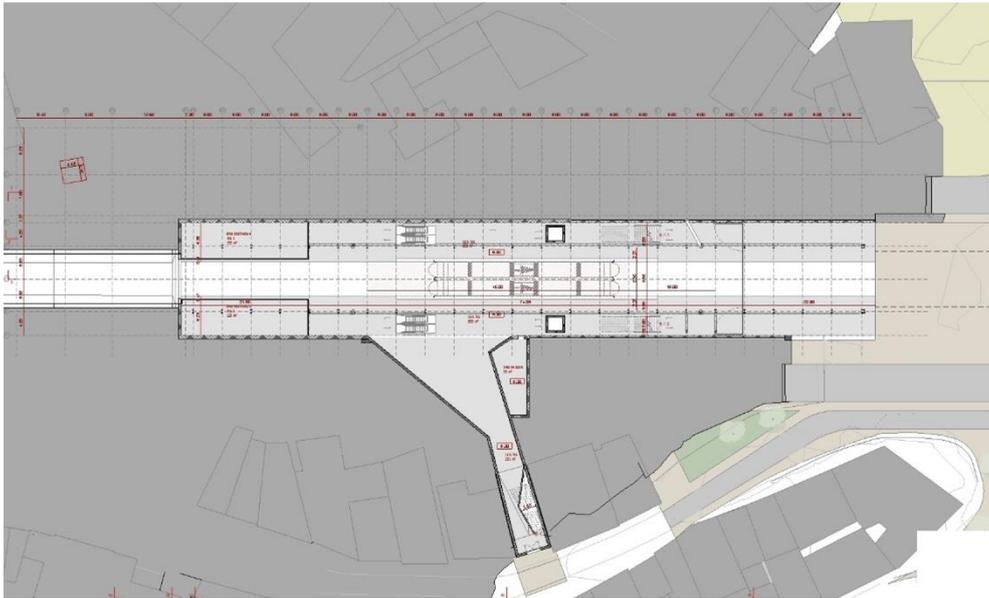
Planta Piso -1 – Cais Lios (ML 134353).
